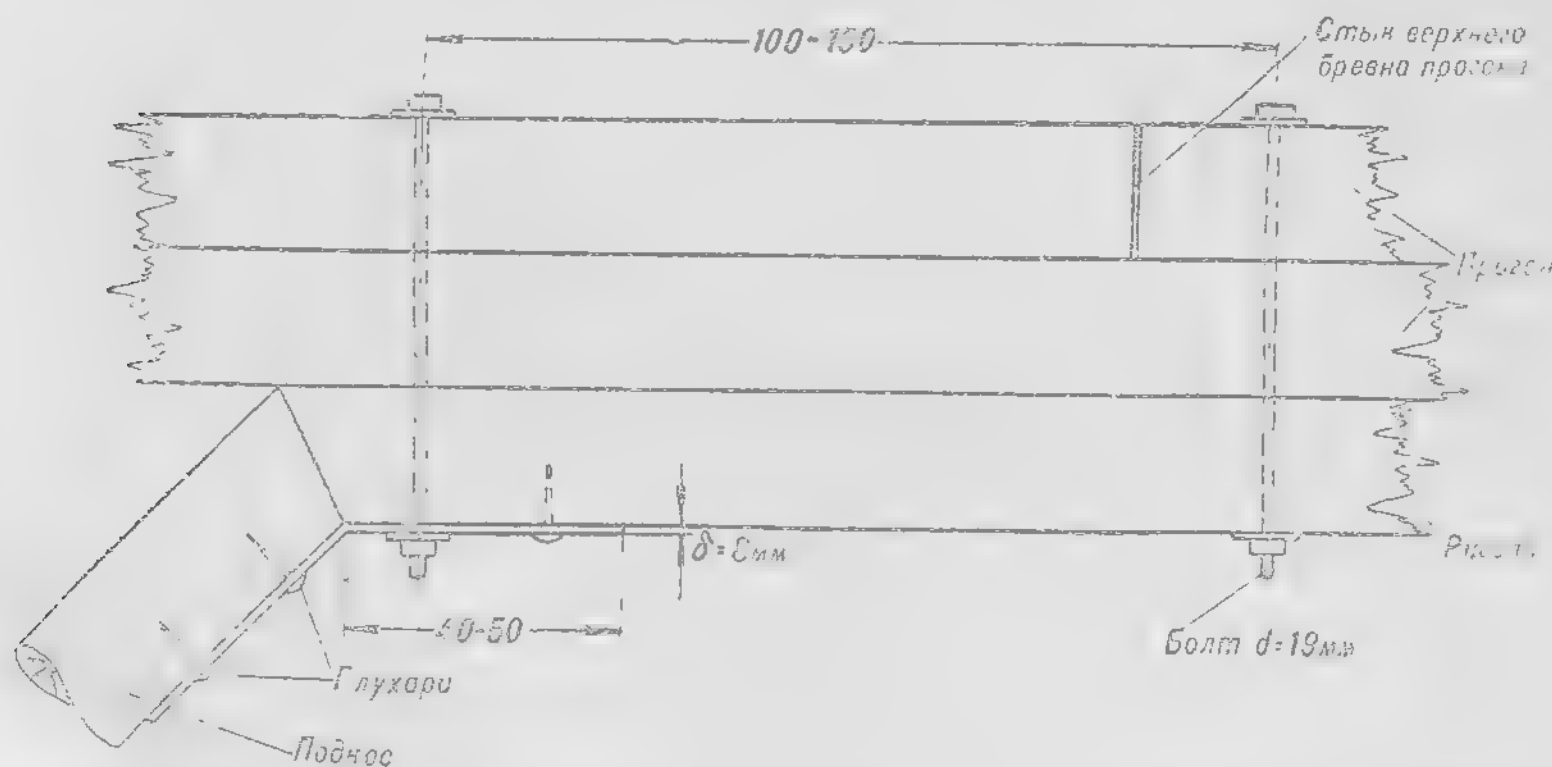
Соединение подкоса с ригелем металлической накладкой.
